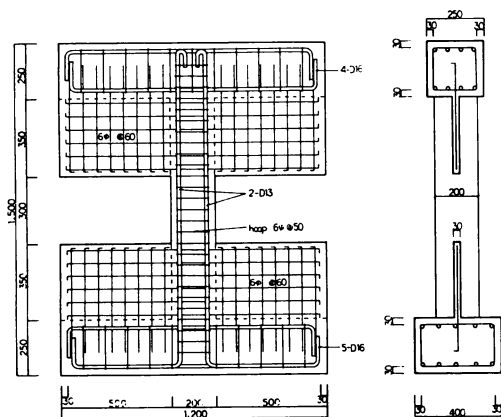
(a) 試験体 CSS01 の配筋図 (寸法単位mm)
